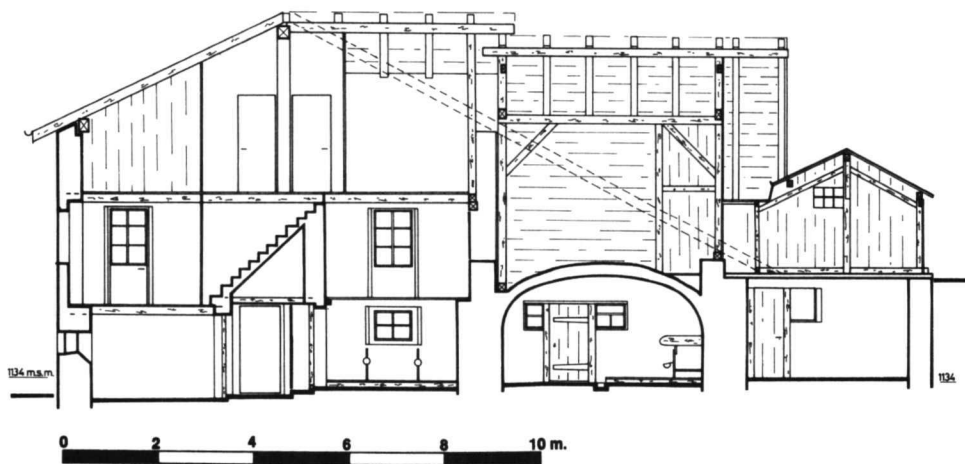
Coupe longitudinale de la maison. — Les lignes en traitillé représentent le plan sud du toit avant les transformations de 1949 (Archéotech 112/7).
